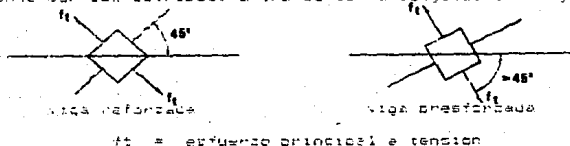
Efecto del prestuerzo longitudinal en la tensión diagonal y en el desarrollo. a) Viga reforzada. b) Viga prestresada.
